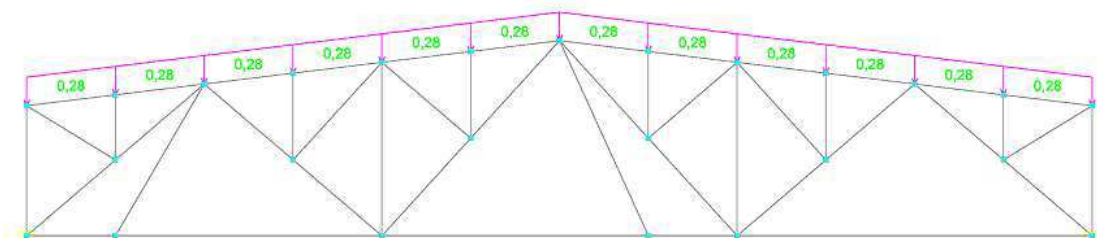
Схема загрузки фермы постоянной нагрузкой от собственного веса кровельных панелей и прогонов
